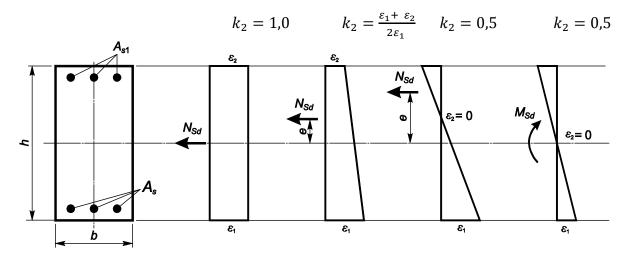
К определению коэффициента k_2 в формуле (8.19)
